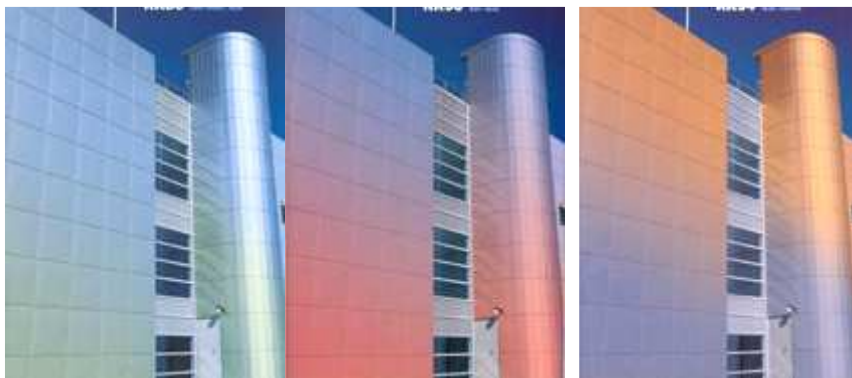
Фасады, облицованные кассетами Хамелеон
